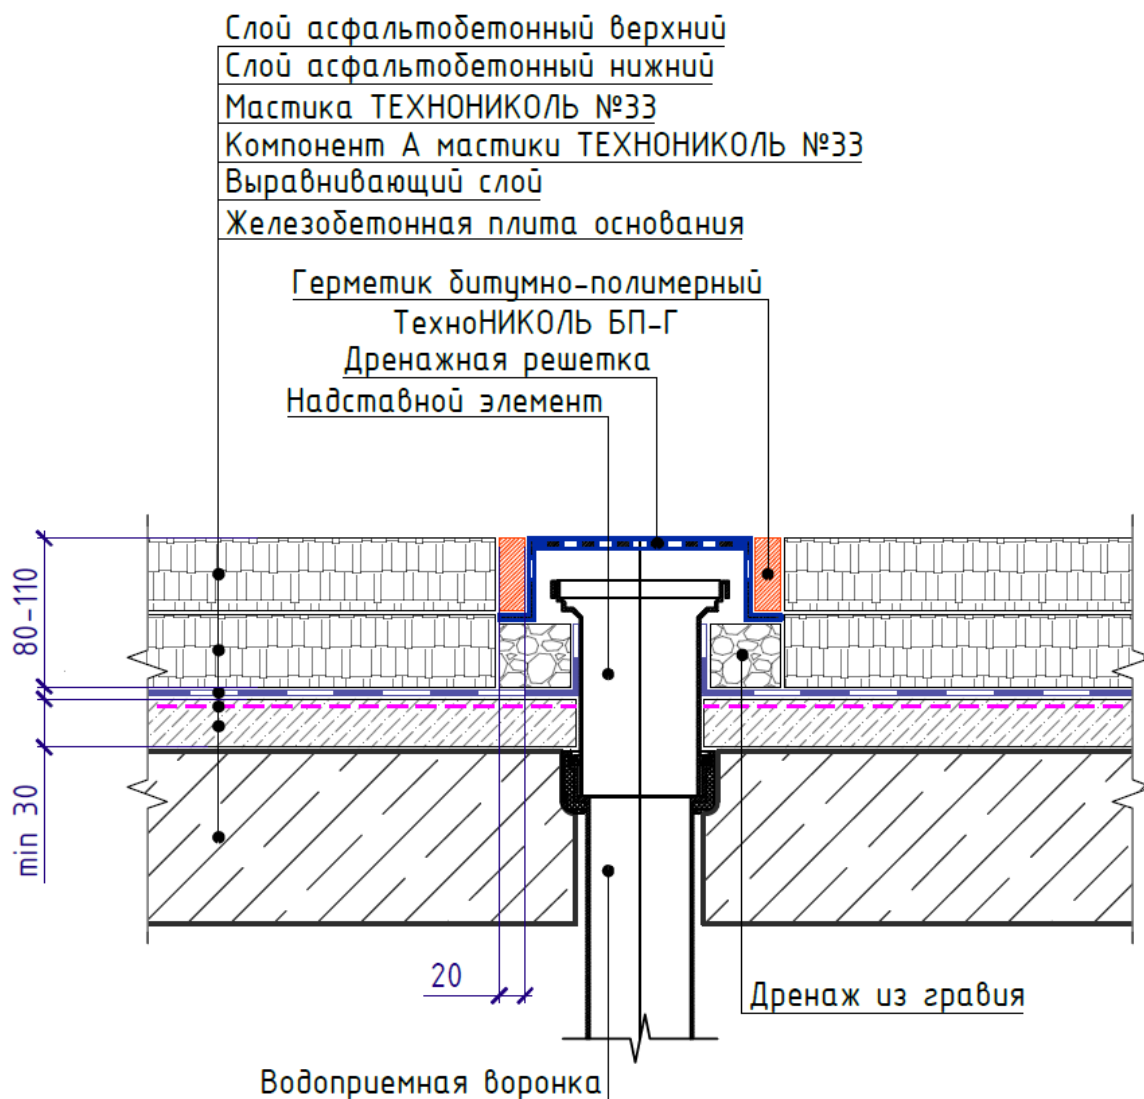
конструкция сопряжения гидроизоляции с водоприемной воронкой
